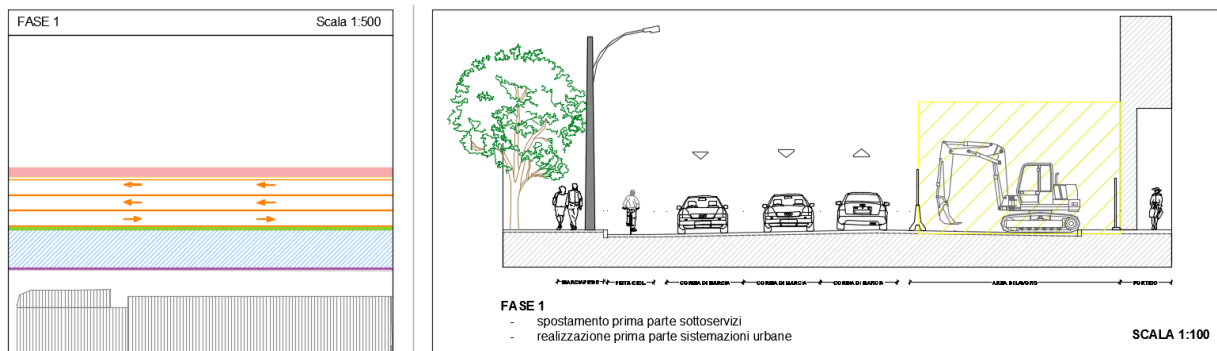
Tipologico cantiere con sede centrale Fase 1
